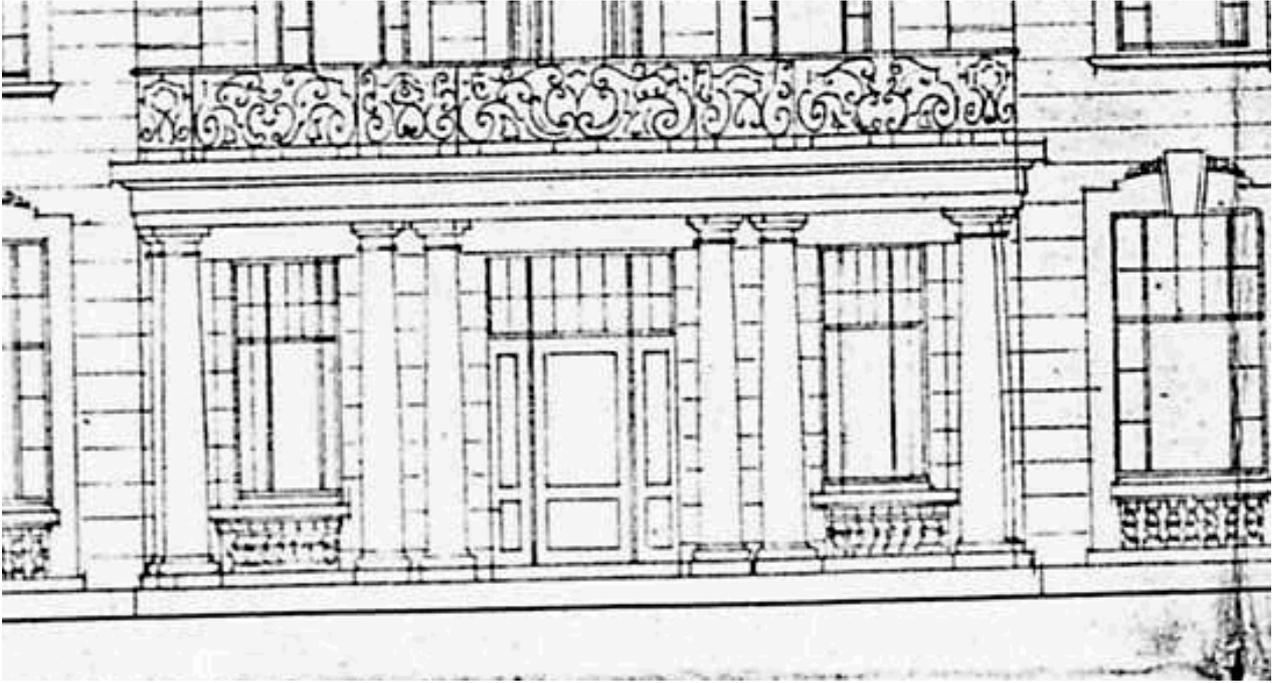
H. Plange, Villa August Kortenbach in Solingen, Detail der Hauptfassade, 1908
